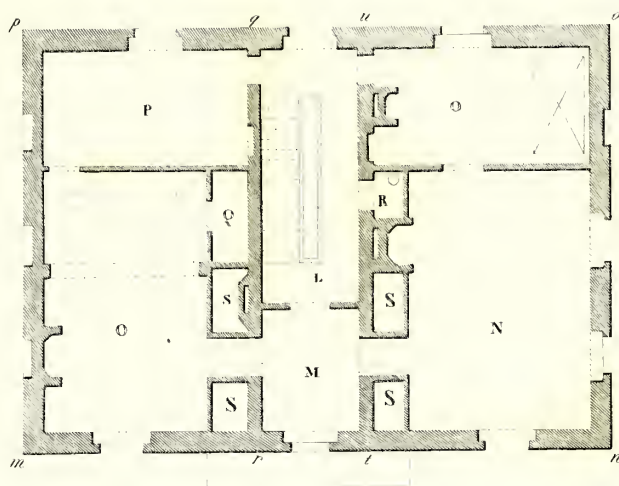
Plan du rez-de-chaussée de ce bâtiment :
